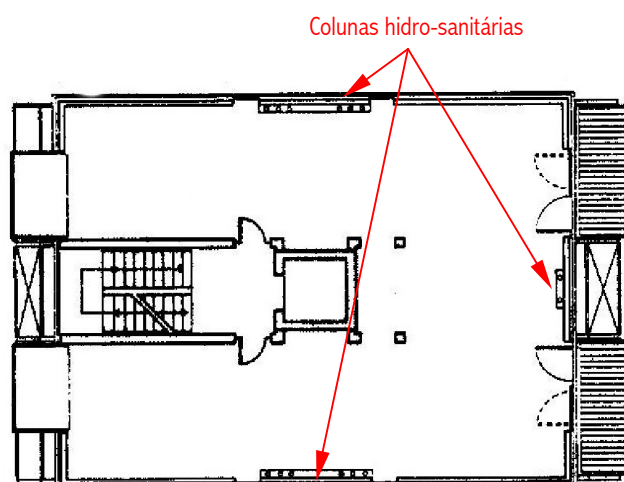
Planta de pavimento-tipo de um edifício de apartamentos e escritórios em Stuttgart, Alemanha; a simetria espacial e a provisão de colunas hidro-sanitárias nos eixos centrais, permite grande variedade de layouts, como é mostrado no Anexo A.21 (Fonte: BECKER, 1992)
